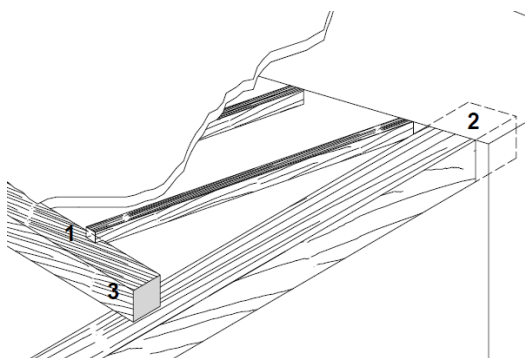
Detalle de la cubierta añadida en trabajos posteriores de la aceña.
